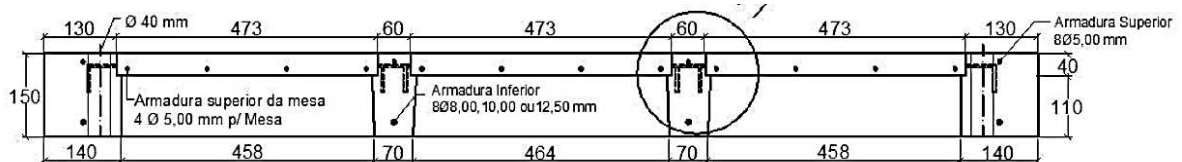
Seção transversal do plano A-A, em mm [Fonte: BORGES (2009)]
